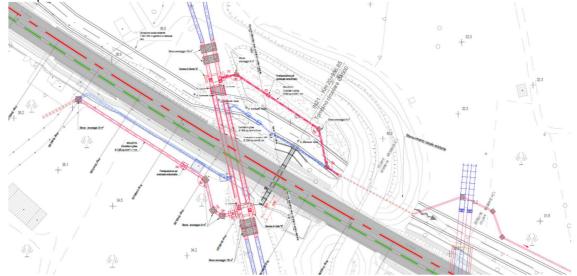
Attraversamento DN1600 pk 21+000 - Stralcio Planimetrico
